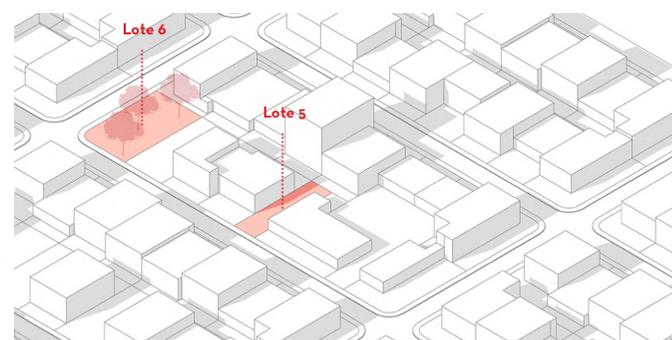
Isometría de Lote tipo 5 y Lote tipo 6
